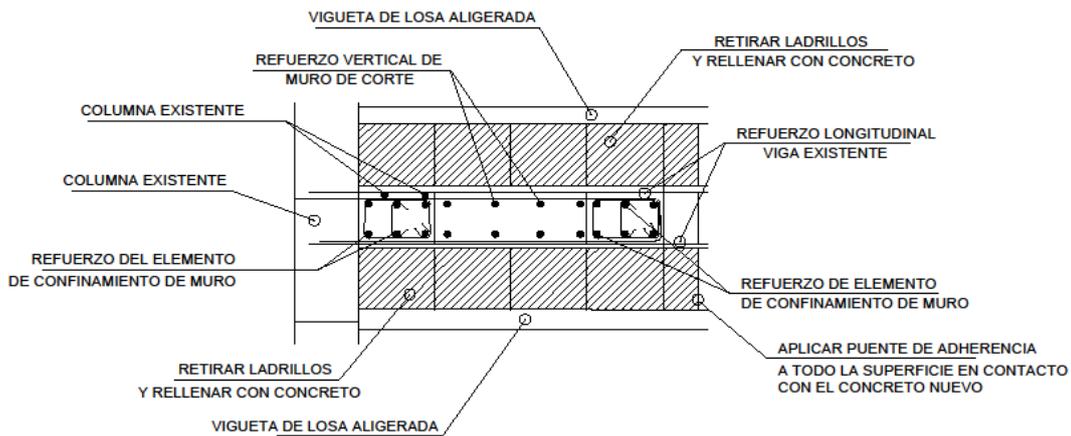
Detalle de muros de corte MC-01 (Módulo de Laboratorio y Aulas)
